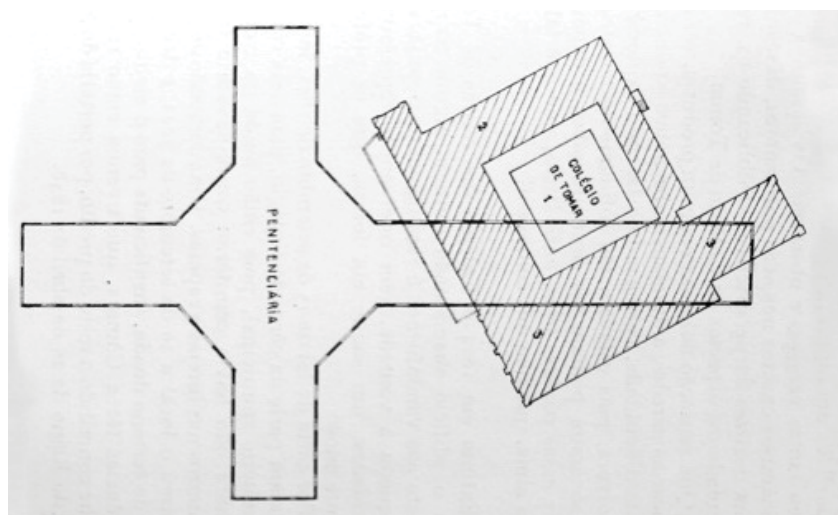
| Planta do Colégio da Ordem de Cristo ou de Tomar
